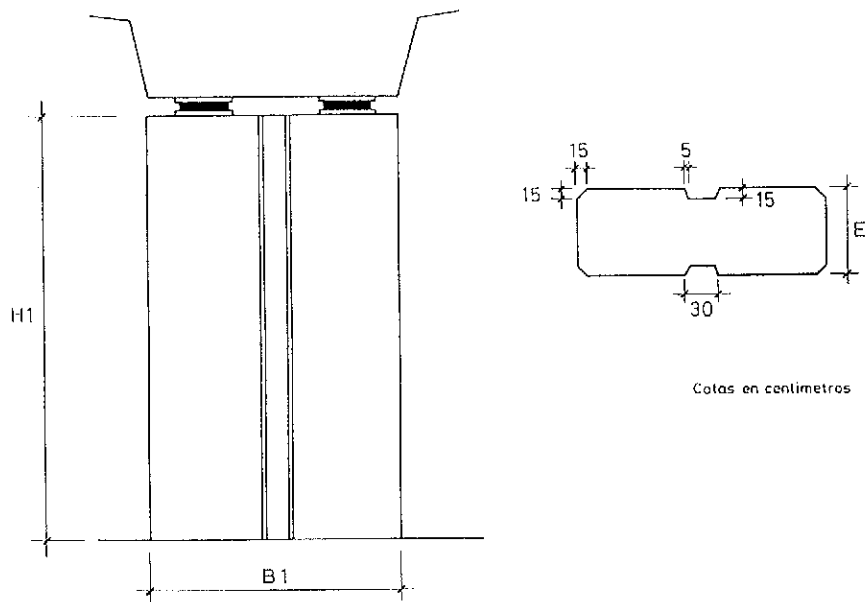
Pila tabique propuesta por el sistema para losas plurinervadas.
